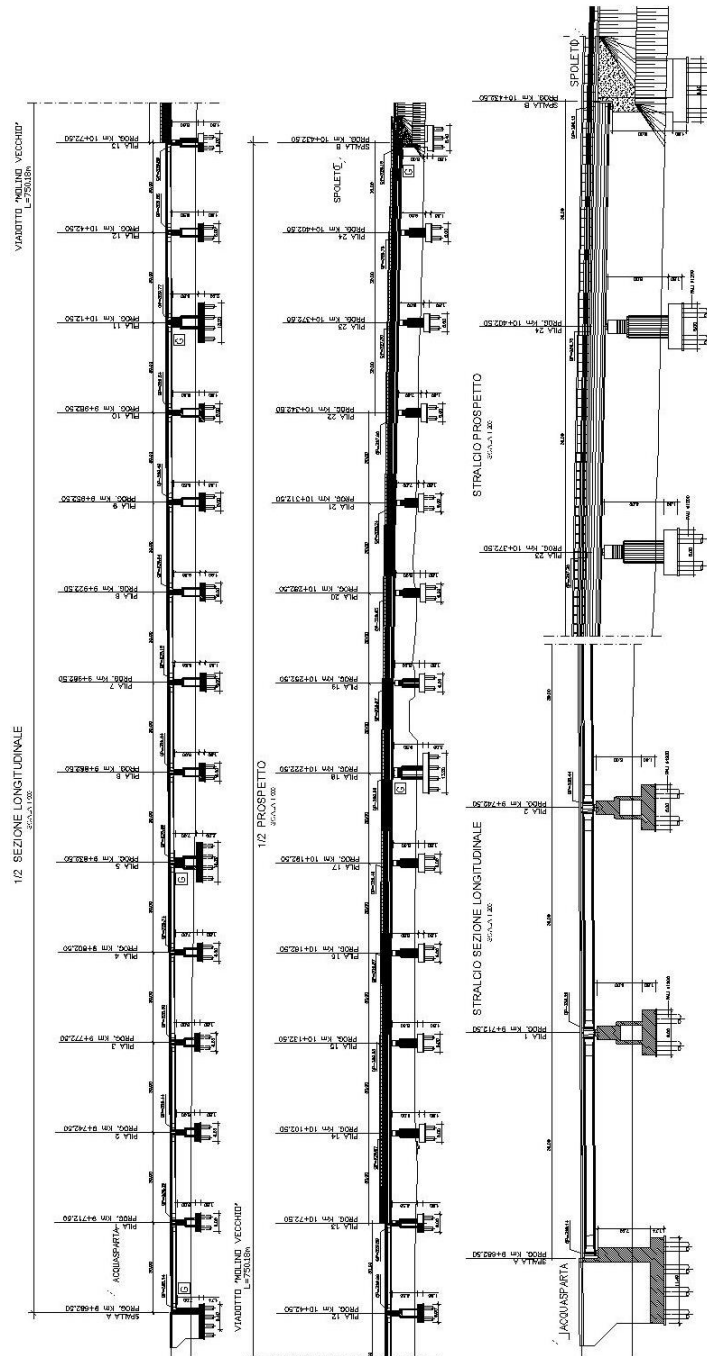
sezione longitudinale e prospetto (stralcio).
